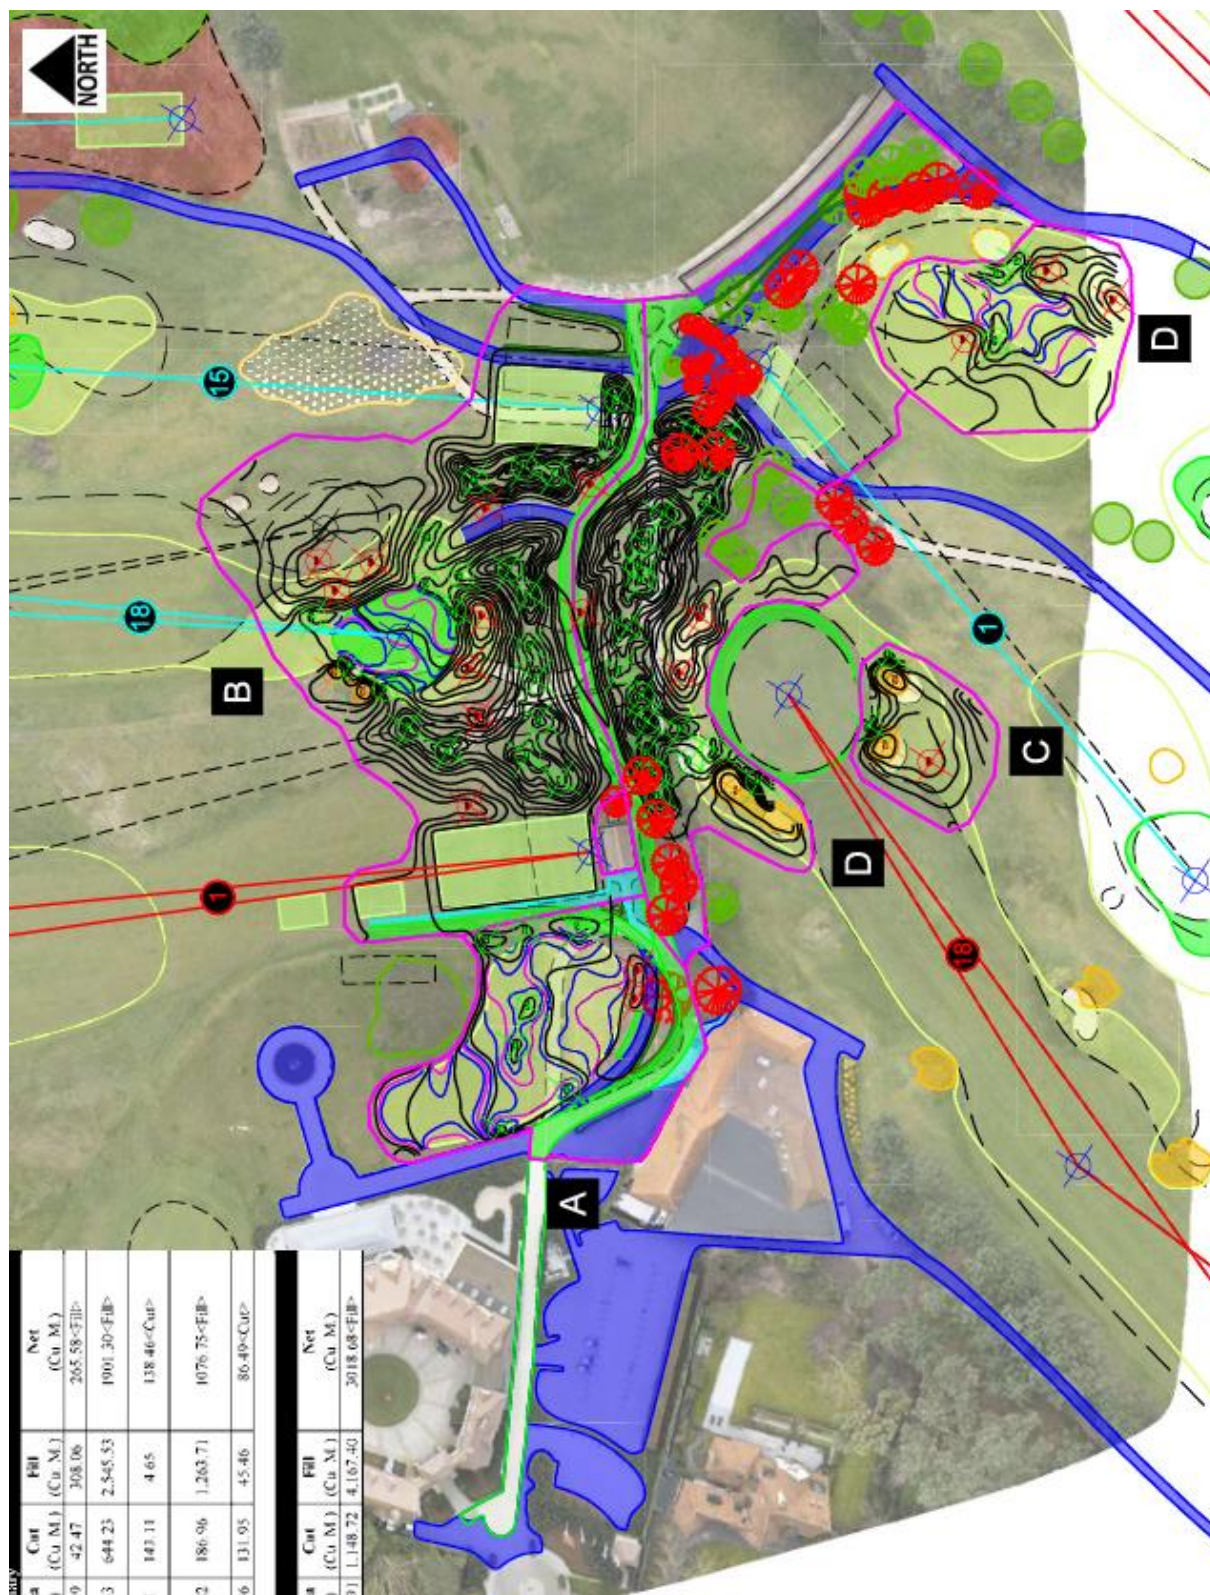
Plan met reeds bestaande leidingen van de ondergrondse beregening van de golf⁵
